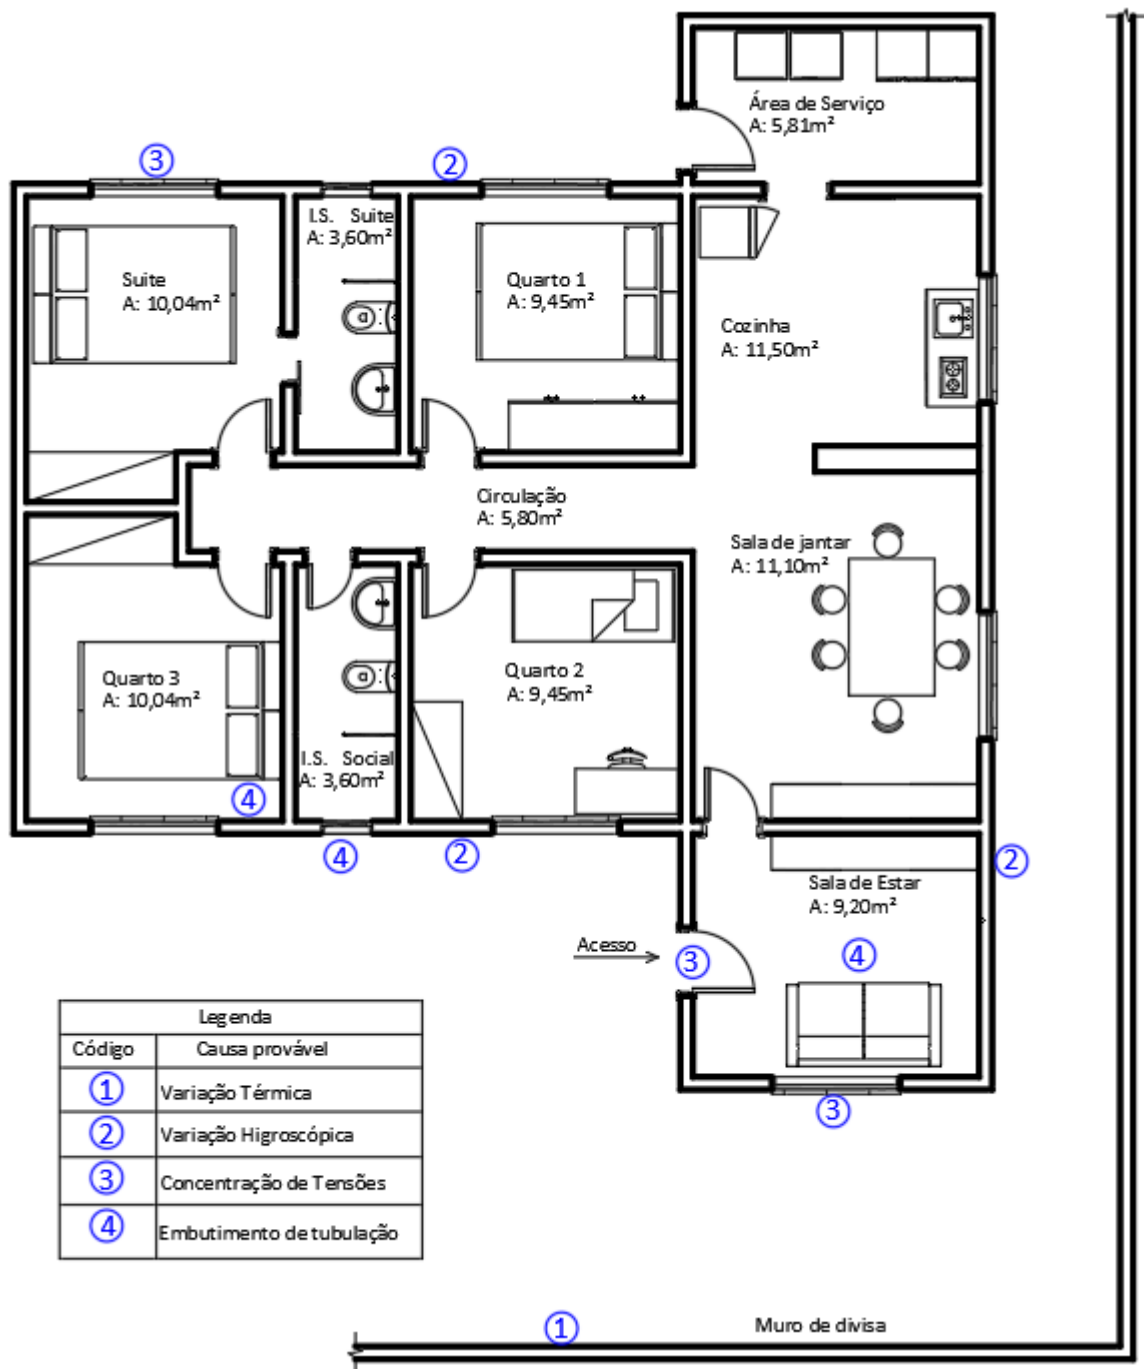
Croqui apresentando os locais com as fissuras encontradas na edificação. Fonte: autor.
